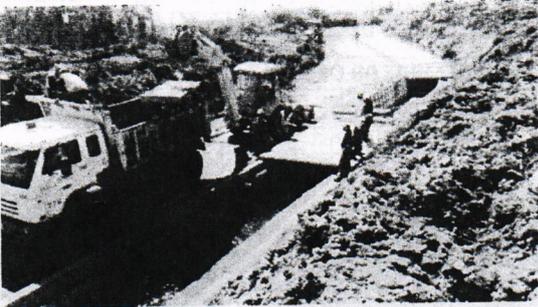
Construcción de cunetas	Foto 2: Construcción de cunetas
